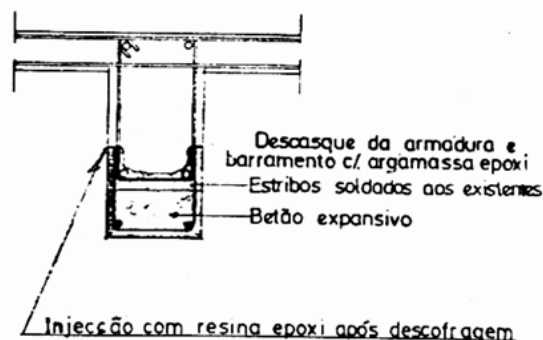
Reforço de viga a flexão por incremento de armadura de tração com aumento da altura da viga (1).
